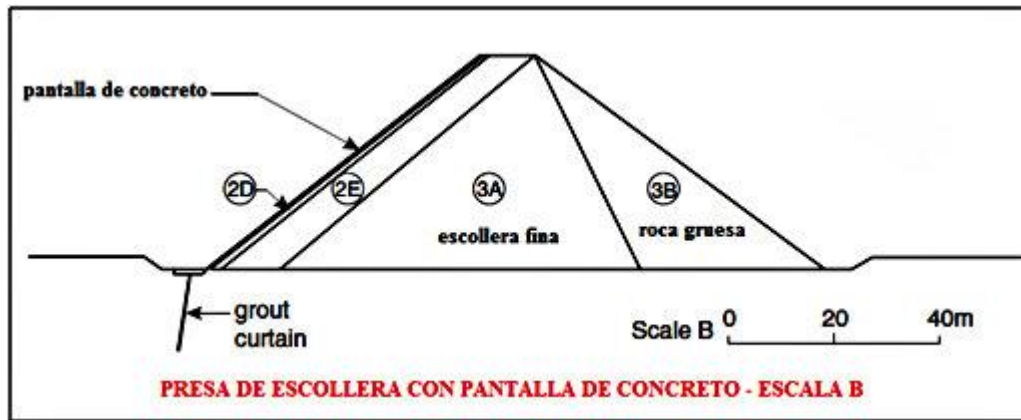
Sección tipo de presa con pantalla impermeabilizadora de concreto.
